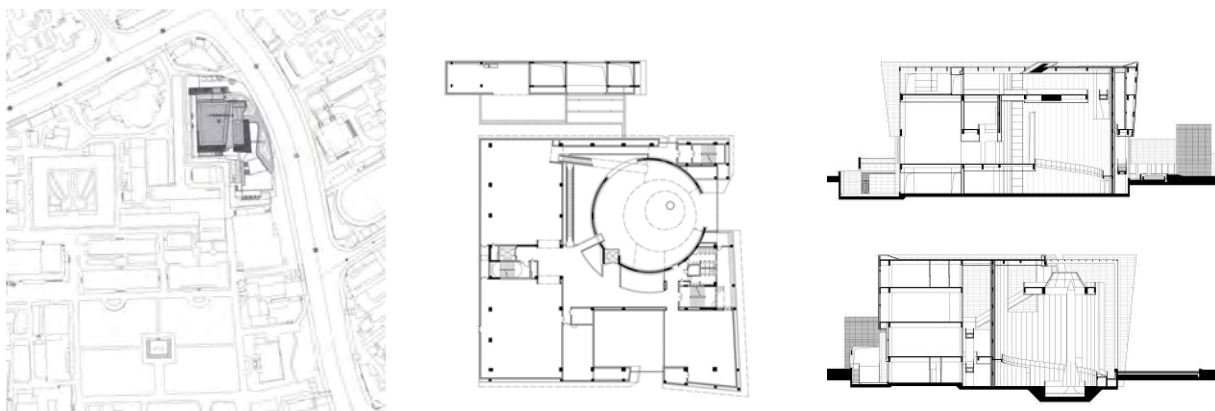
总平面图、平面图与剖面图 (来源:设计文件)
